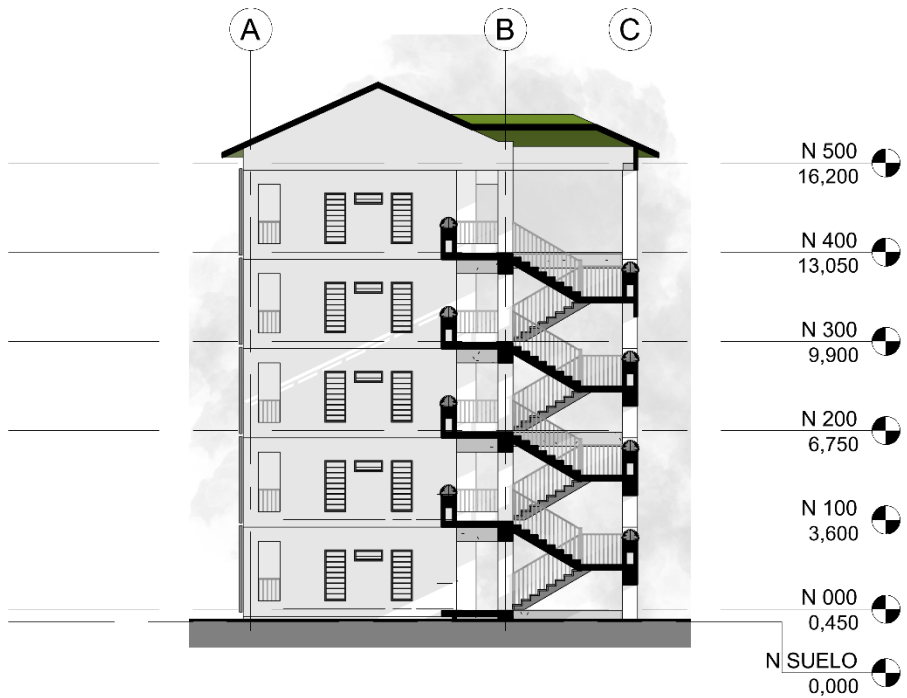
SECCIÓN TRANSVERSAL EDIFICIO 2 | Elaborado por: El autor
